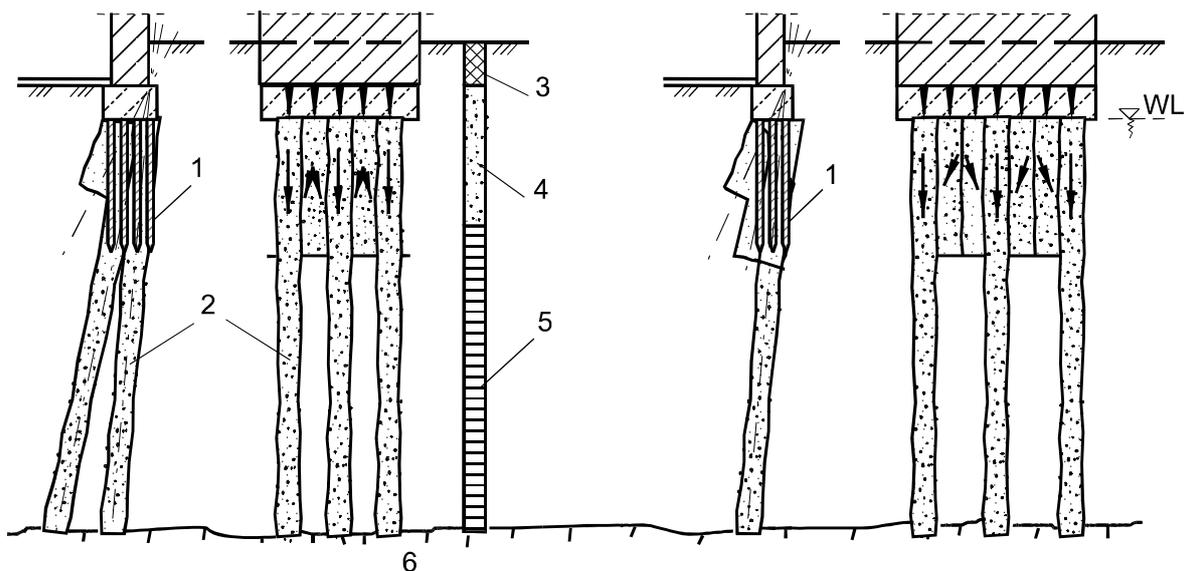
Схема пересадки фундаментов Малого театра в Москве: 1 – деревянные сваи; 2 – выполненные по струйной технологии опоры; 3 – насыпной грунт; 4 – песок; 5 – глина; 6 – известняк
